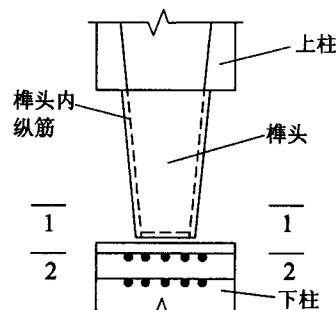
構式柱连接施工吊装阶段验算截面
